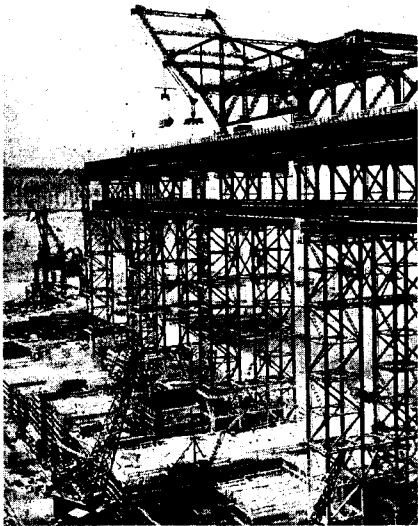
Укладка бетона в метод «термоса» и монтаж высокой эстакады на Братской ГЭС
